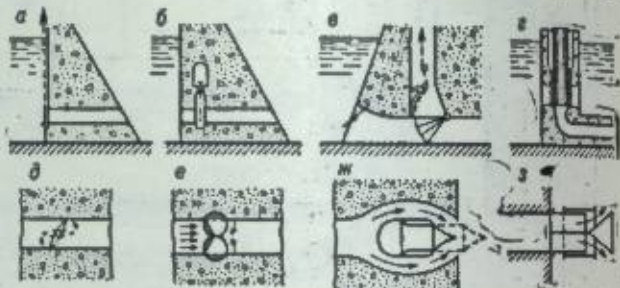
Схемы глубинных затворов: а — плоский; б — задвижка; в — сегментный; г — цилиндрический высокий; д — дроссельный; е — шаровой; ж — игольчатый; з — телескопический.
